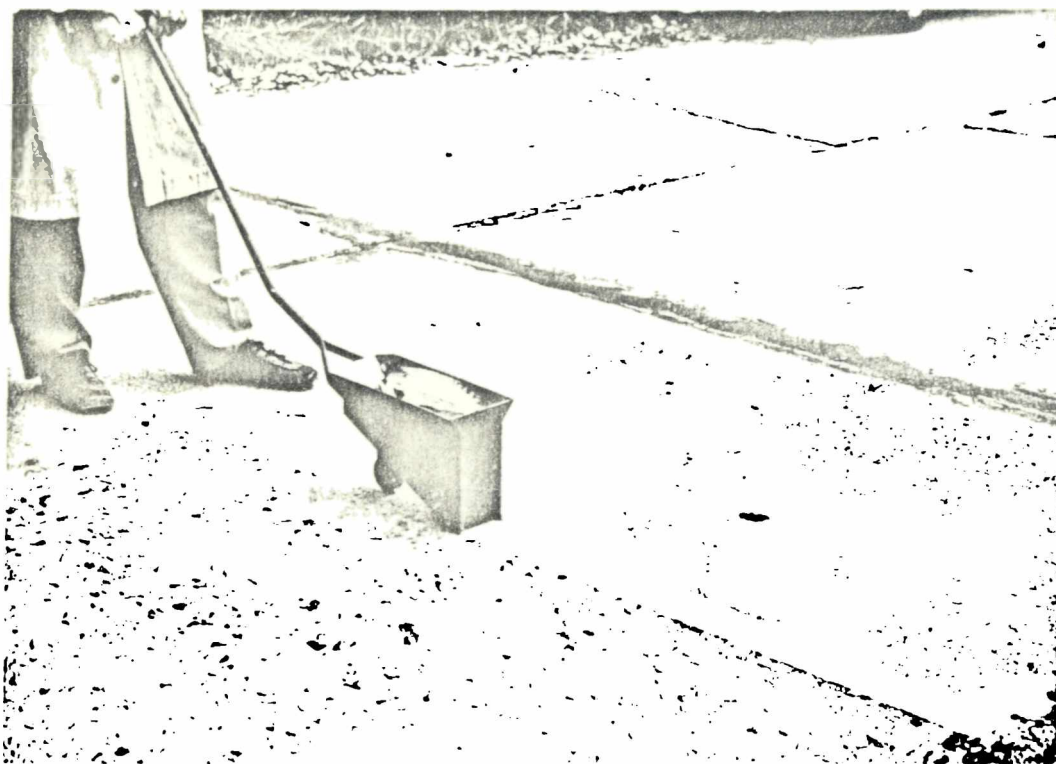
Aplicación sobre pavimento para ensayo en servicio
